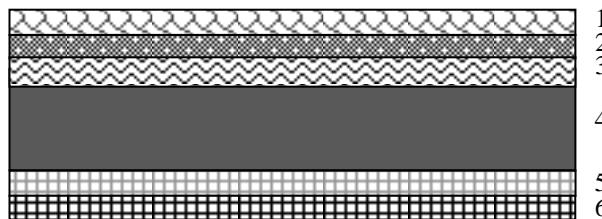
Coupe verticale du plancher courant à dalle pleine.
